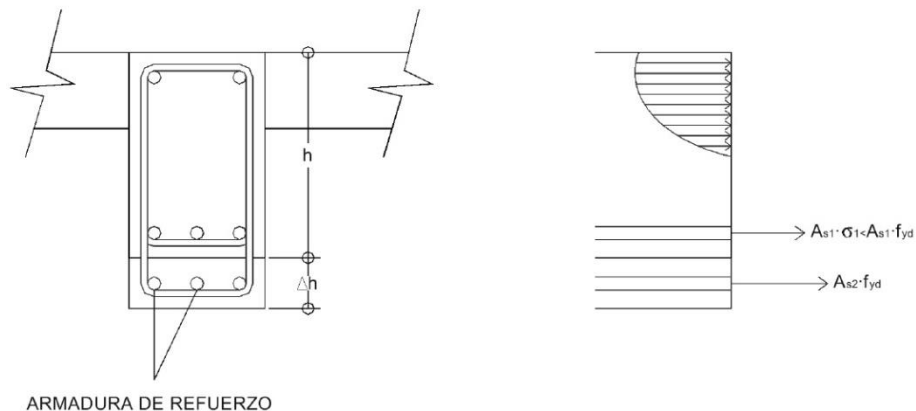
Recreido de viga con adición de armadura para refuerzo a flexión.
